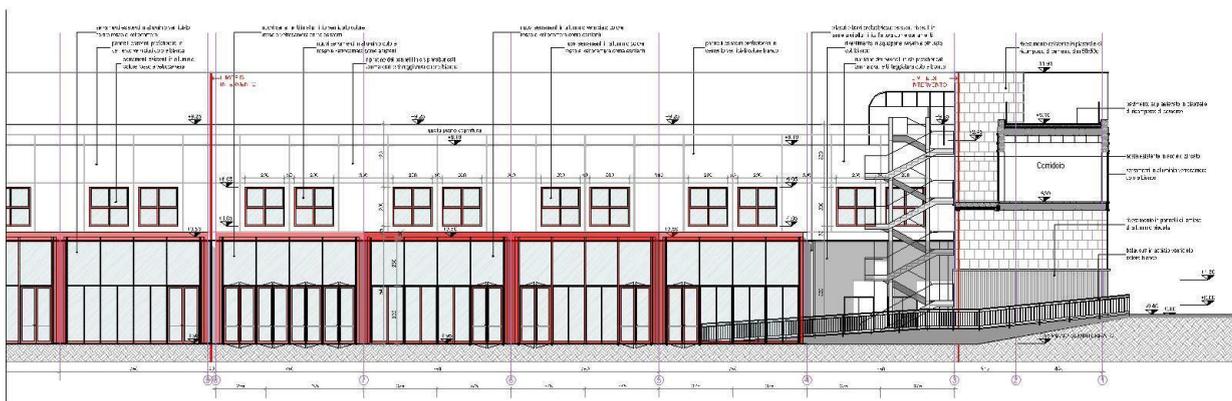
Stato di Progetto – Prospetto Ovest sul cortile interno
